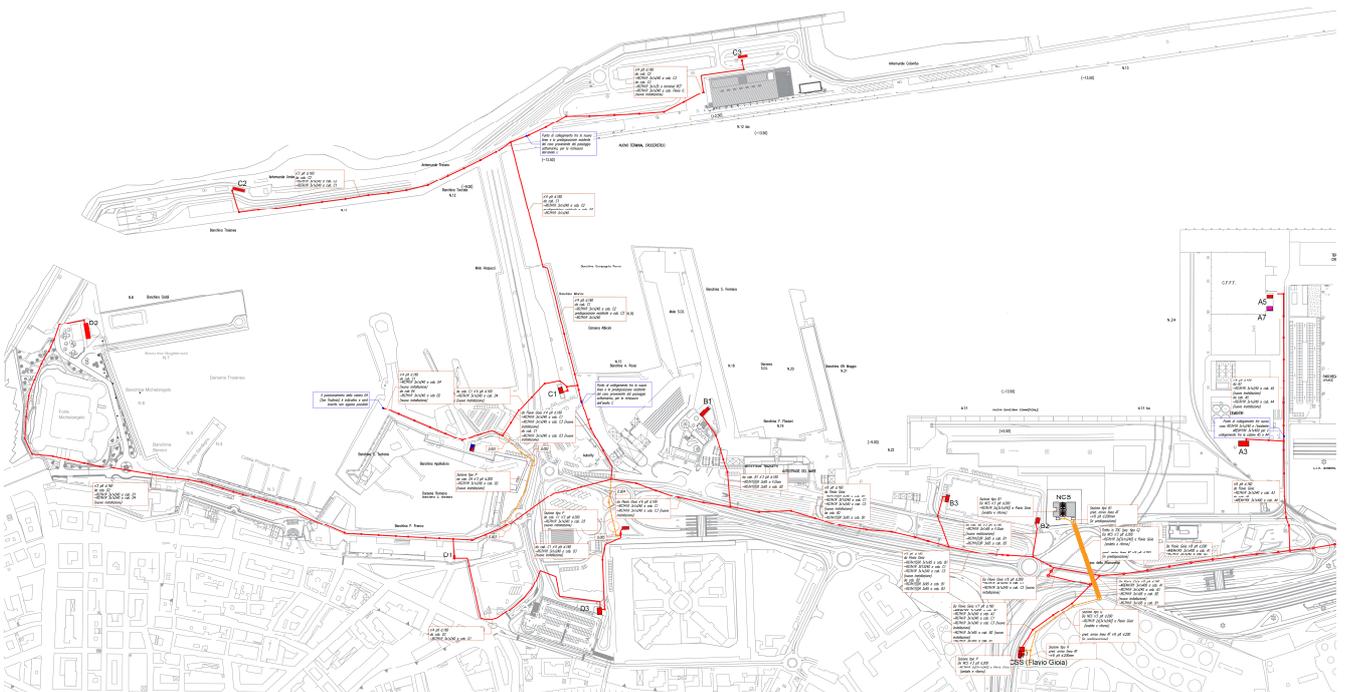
Implementazione vie cavo MT rete portuale – Zona Sud
